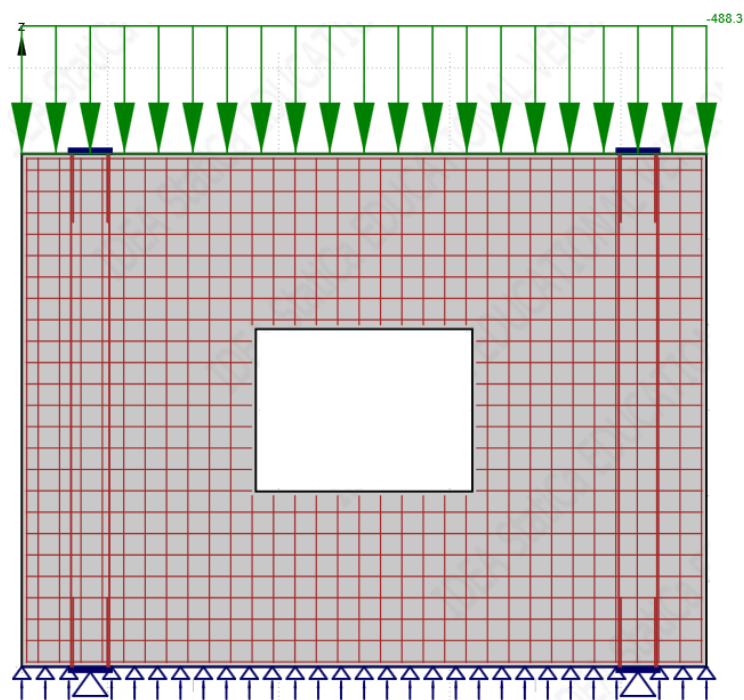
Aplicação da carga vertical na parede em estudo (ELU).
